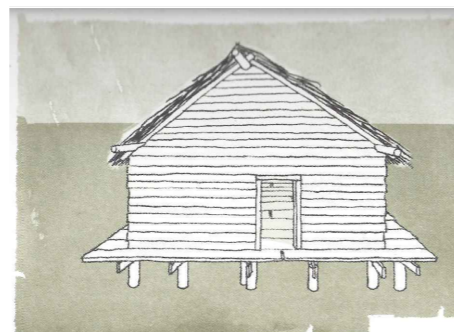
| Construção de uma palafita - Elevação da estrutura.
